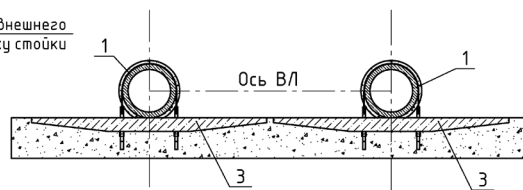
Схема монтажа ригеля для опор, устанавливаемых в котлован
